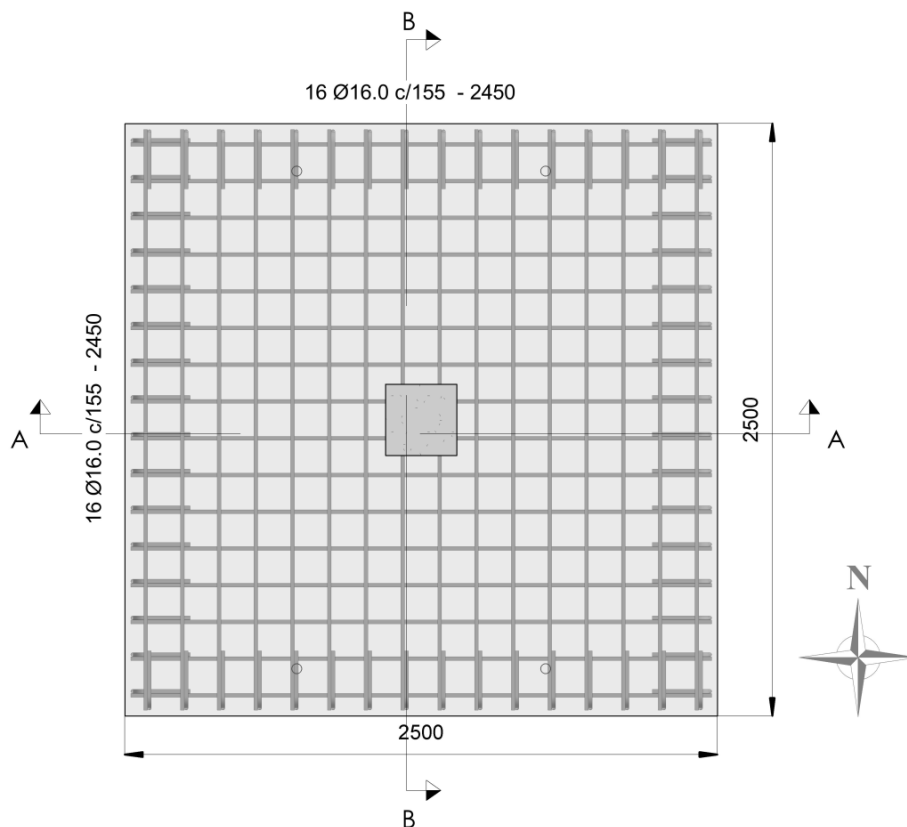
Detalhamento das armaduras de flexão tracionada (medidas em milímetros)
